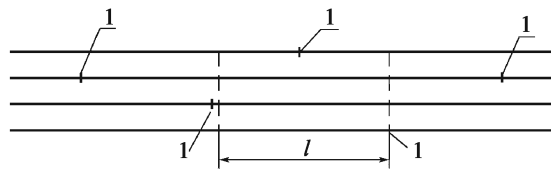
Disposition au niveau de la zone de soudure
